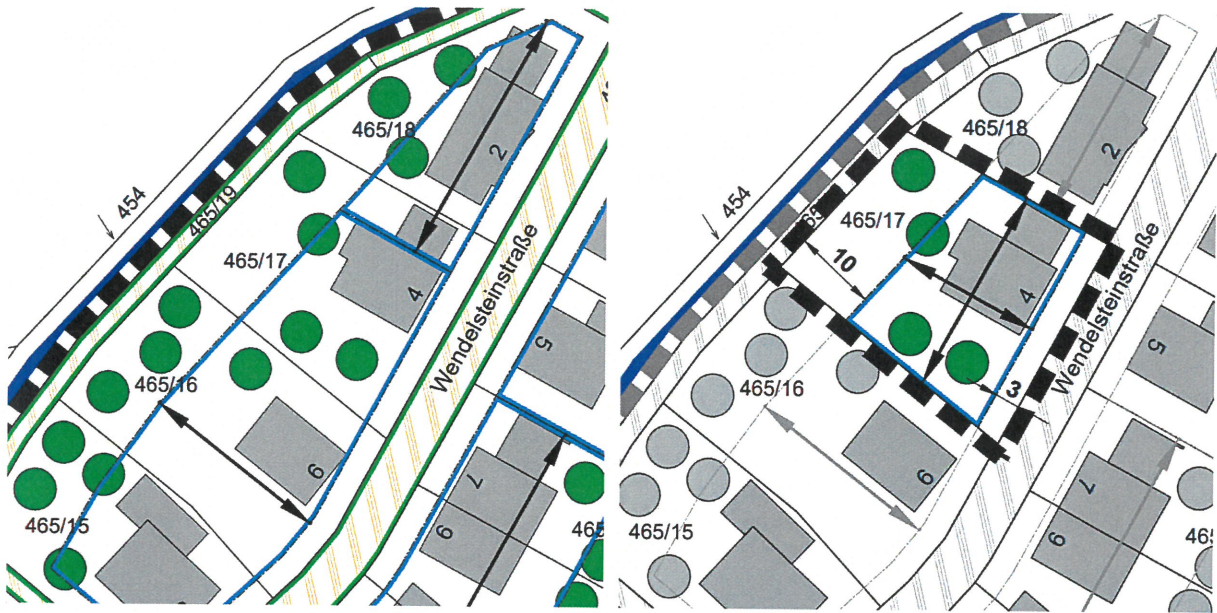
Zulässige Firstrichtung auf Grundstück 465/17 im derzeit rechtkräftigen Bebauungsplan (links) und mit der vorliegenden 2. Änderung (rechts).
